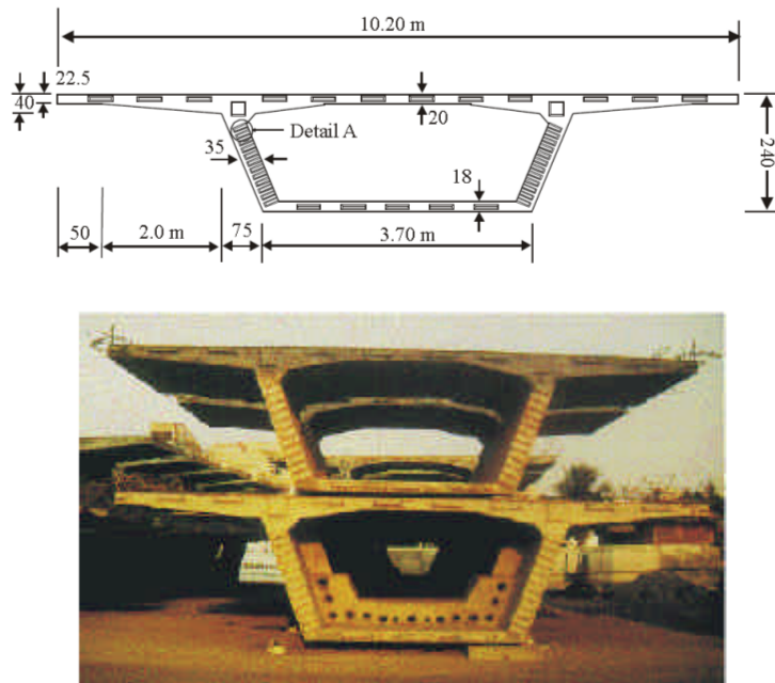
Geometría de las dovelas del puente Second Stage Expressway System modelizado por Rombach [41]
